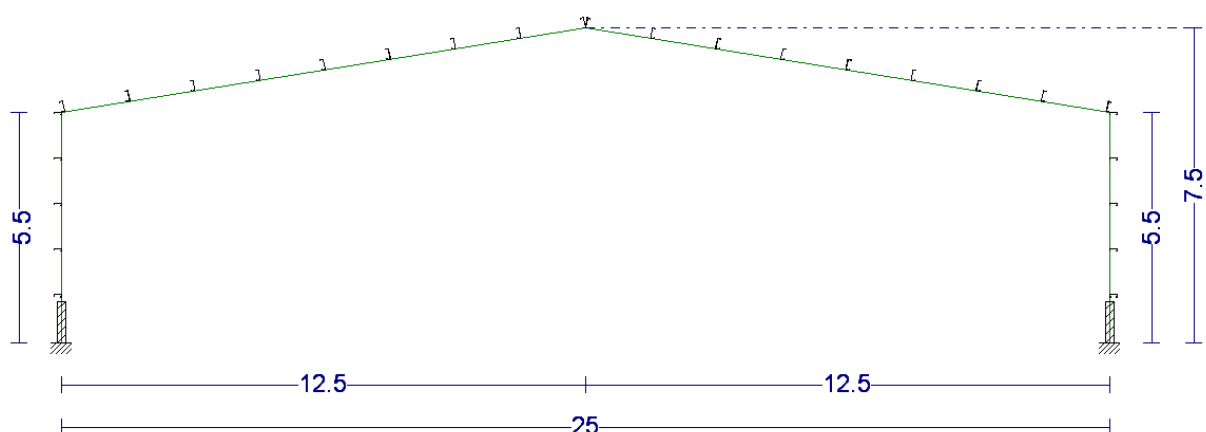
Geometría pórtico tipo junto a las disposiciones de correas y muro de contención
